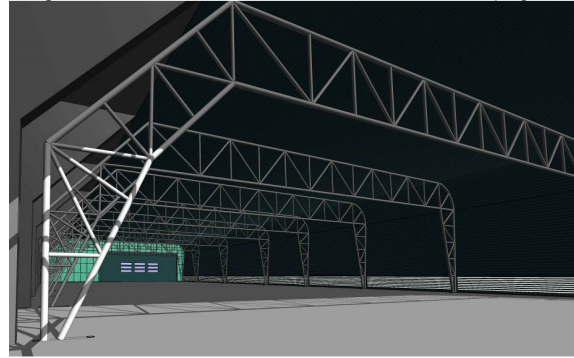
Struttura di acciaio dell'Avanfossa con il piazzale per il conferimento
